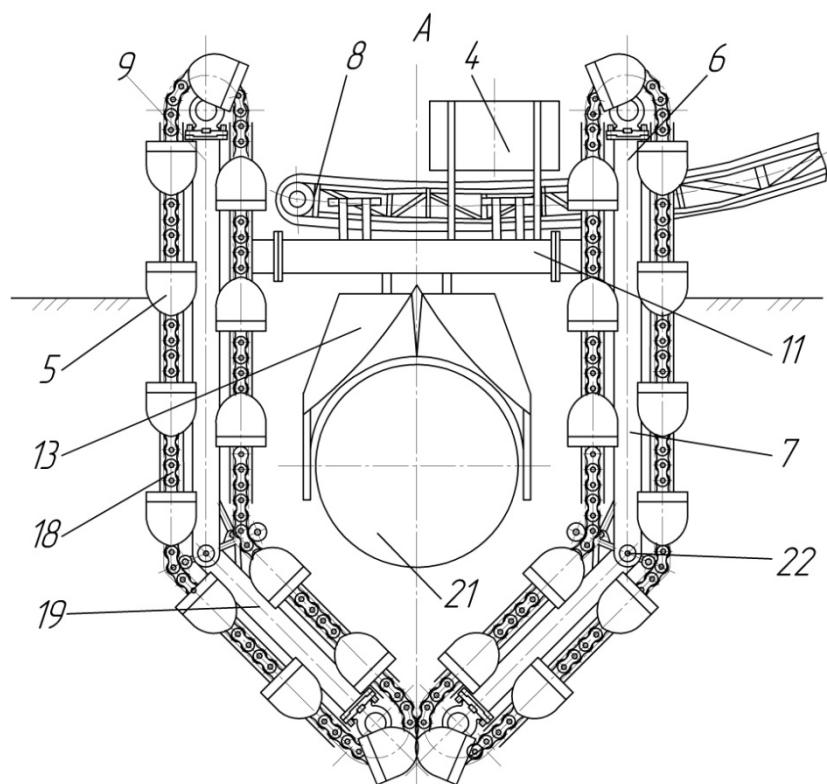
Багатоковшевий адаптований робочий орган поперечного копання, вид А на рис. 1
